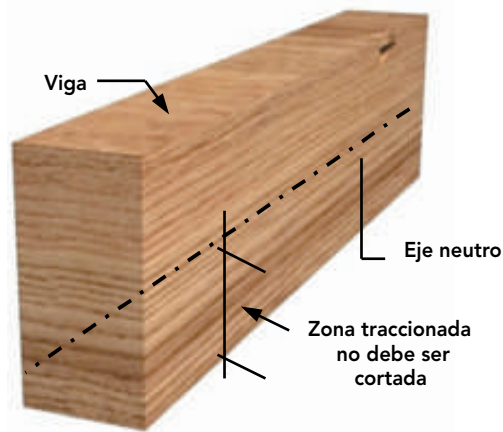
Las vigas no deben ser debilitadas con cortes en la zona traccionada.
